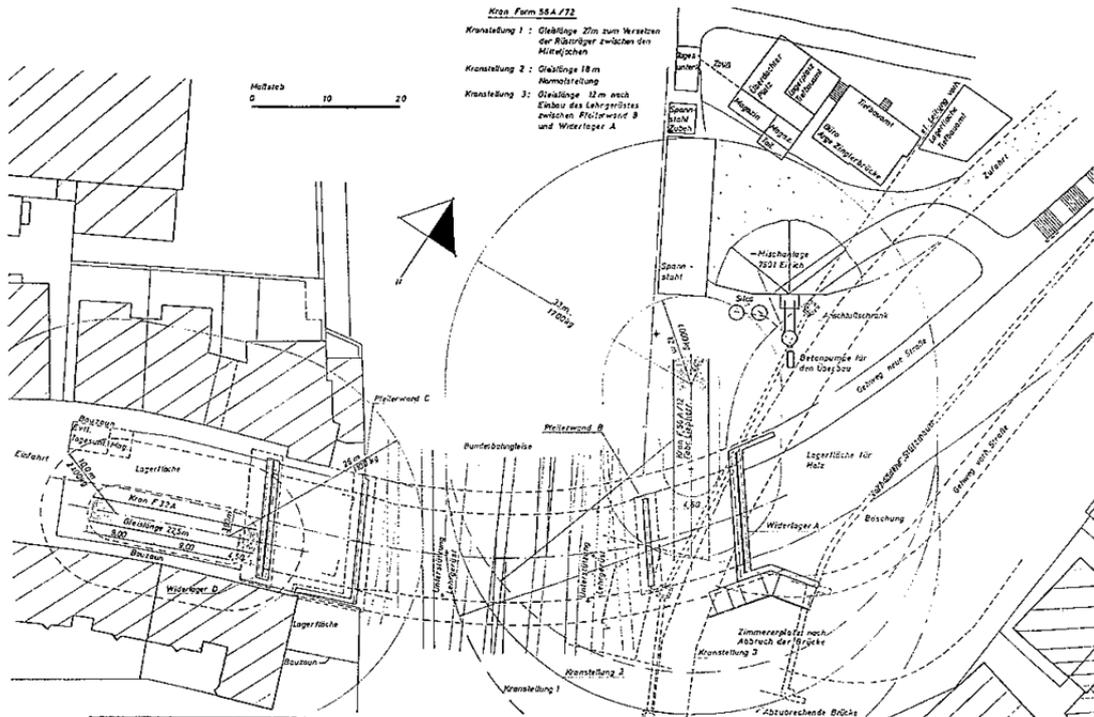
Baustelleneinrichtung - Zingler-Brücke, Ulm [1]
